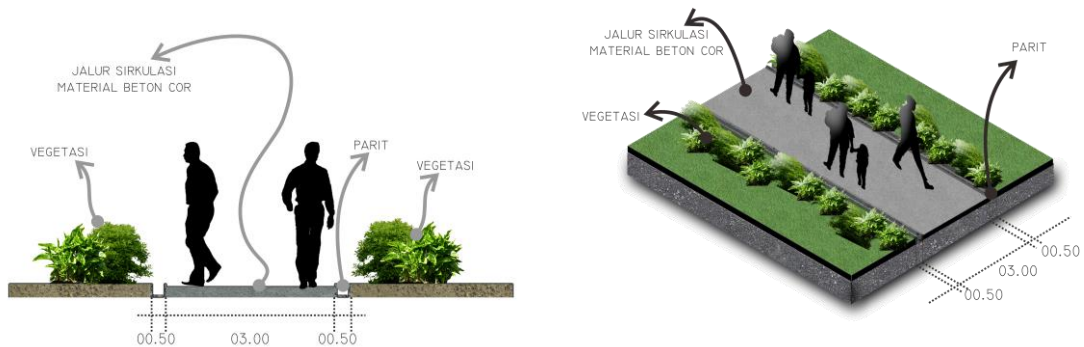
24. view sepanjang jalur Alun alun kota batu menuju Agrotechno aprk universitas Brawijaya
